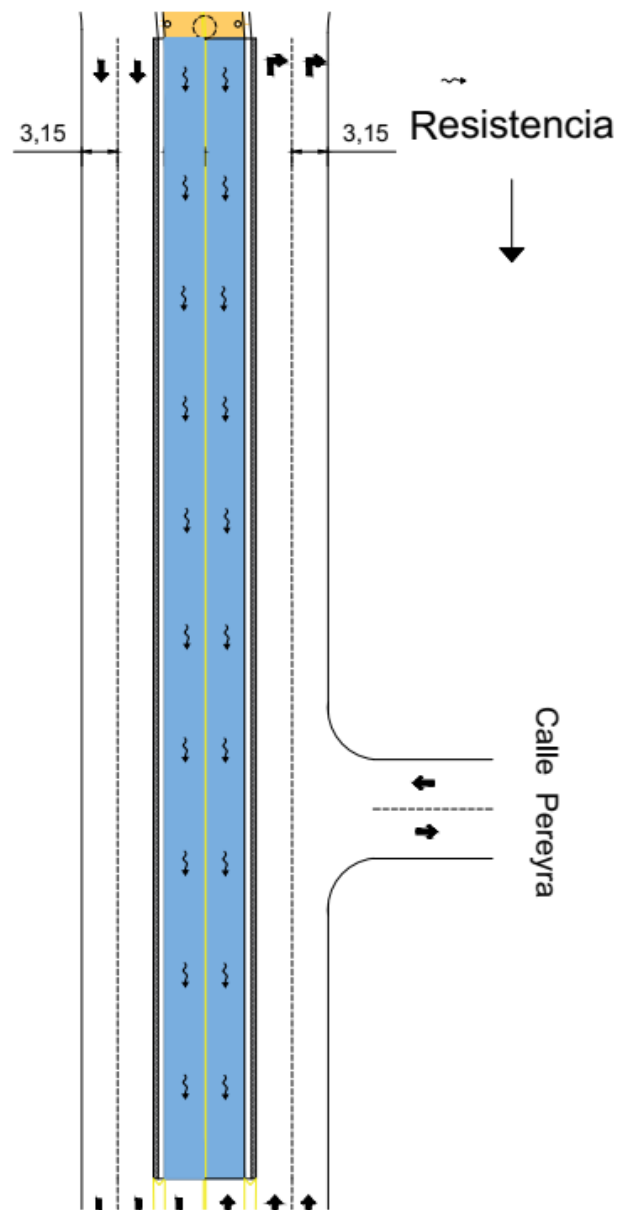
Zona CENTRAL (fuente: elaboración propia)
